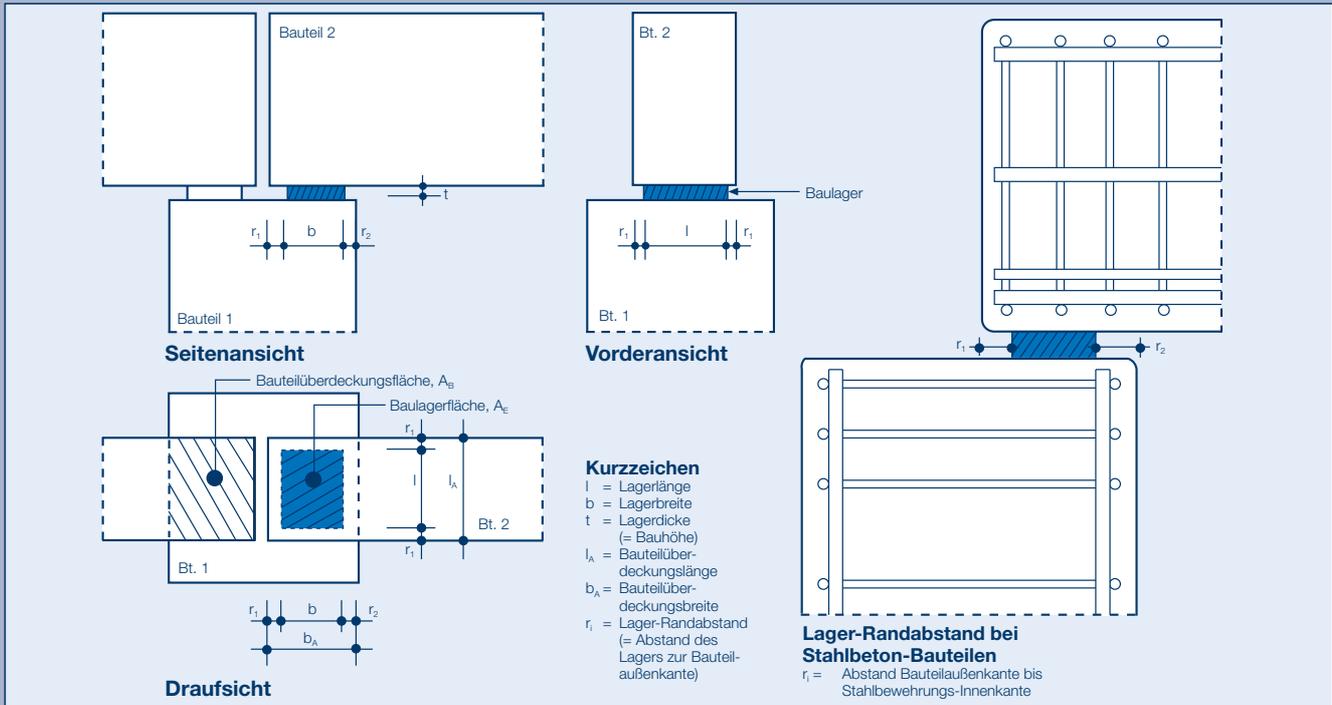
Maximale Größe der Grundrissfläche eines Elastomers unter Berücksichtigung der Randabstände nach Heft 600, Deutscher Ausschuss für Stahlbetonbau. Im Stahlbau sollte der Randabstand zur Bauteilaußenkante mindestens 10 mm betragen.
